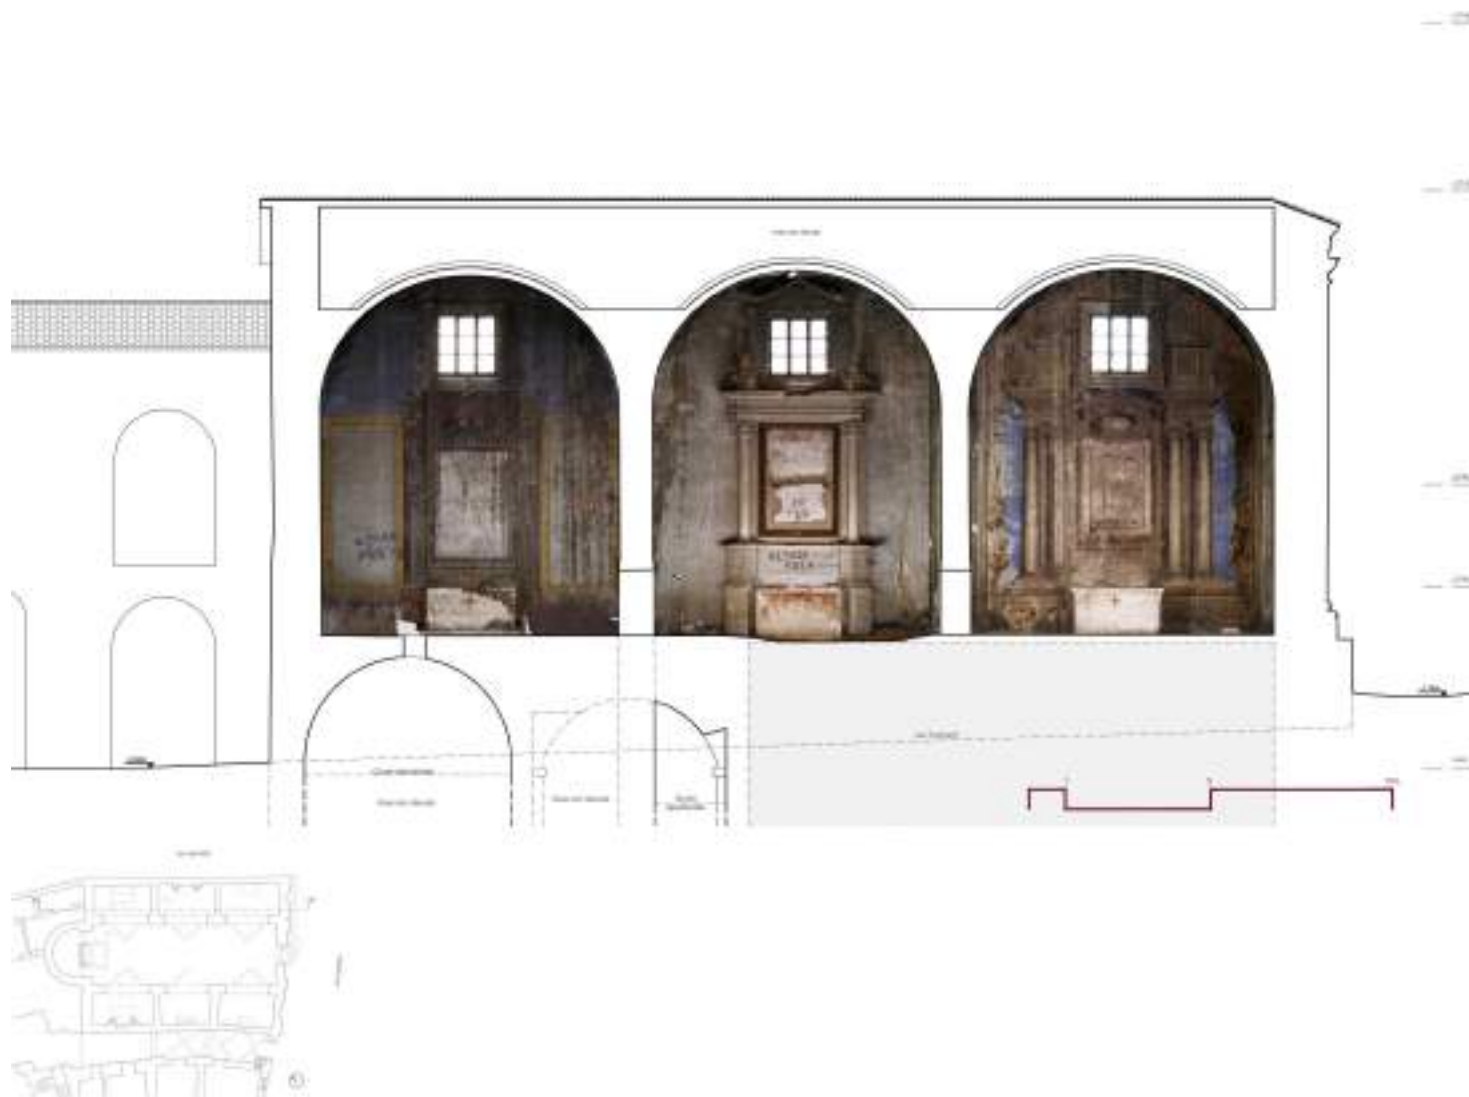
/ Sezione longitudinale DD' con ortofoto.
